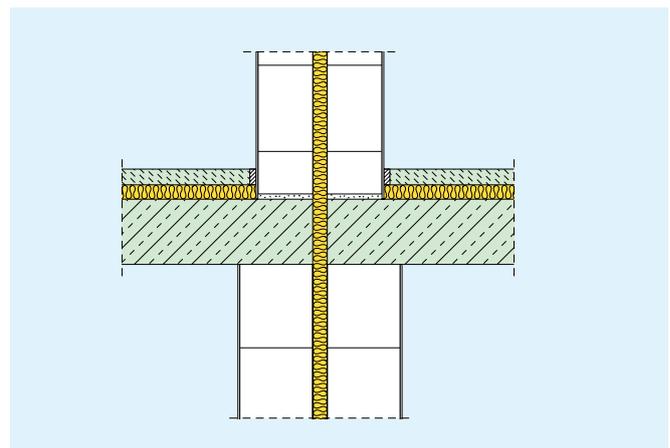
Deckenanschluss einer zweischaligen Haustrennwand
